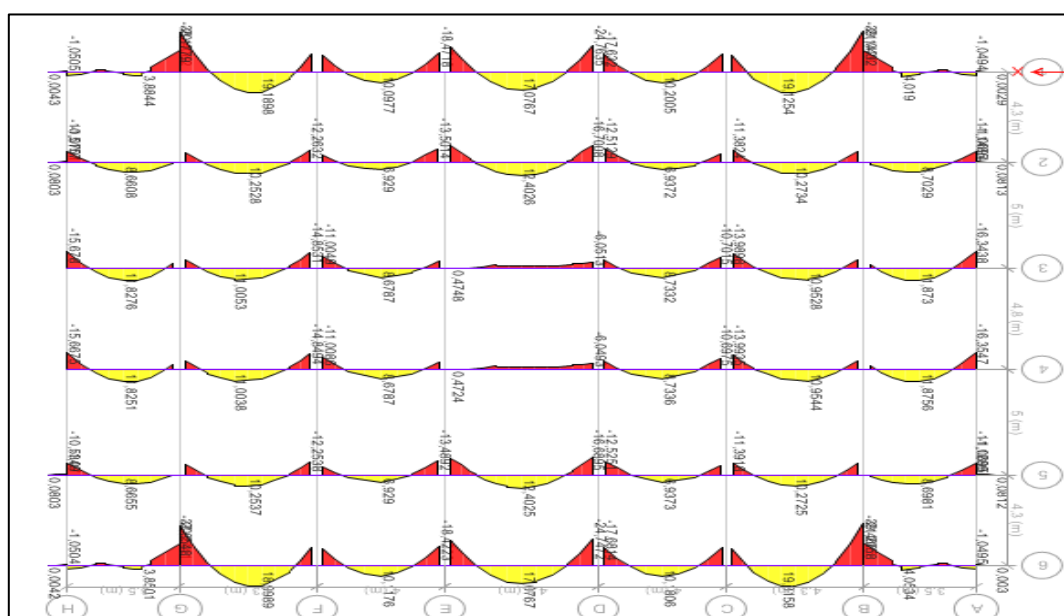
Moment fléchissant des poutres secondaires(ELU)
